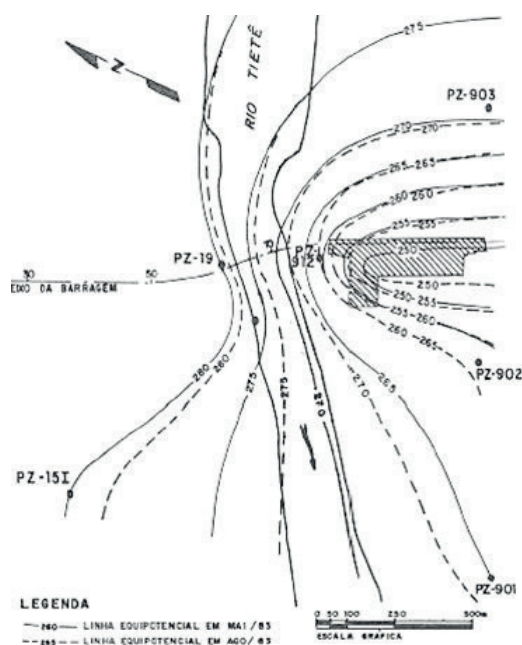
Três Irmãos - Localização dos piezômetros e equipotenciais antes das escavações (Silveira & outros, 1987).
